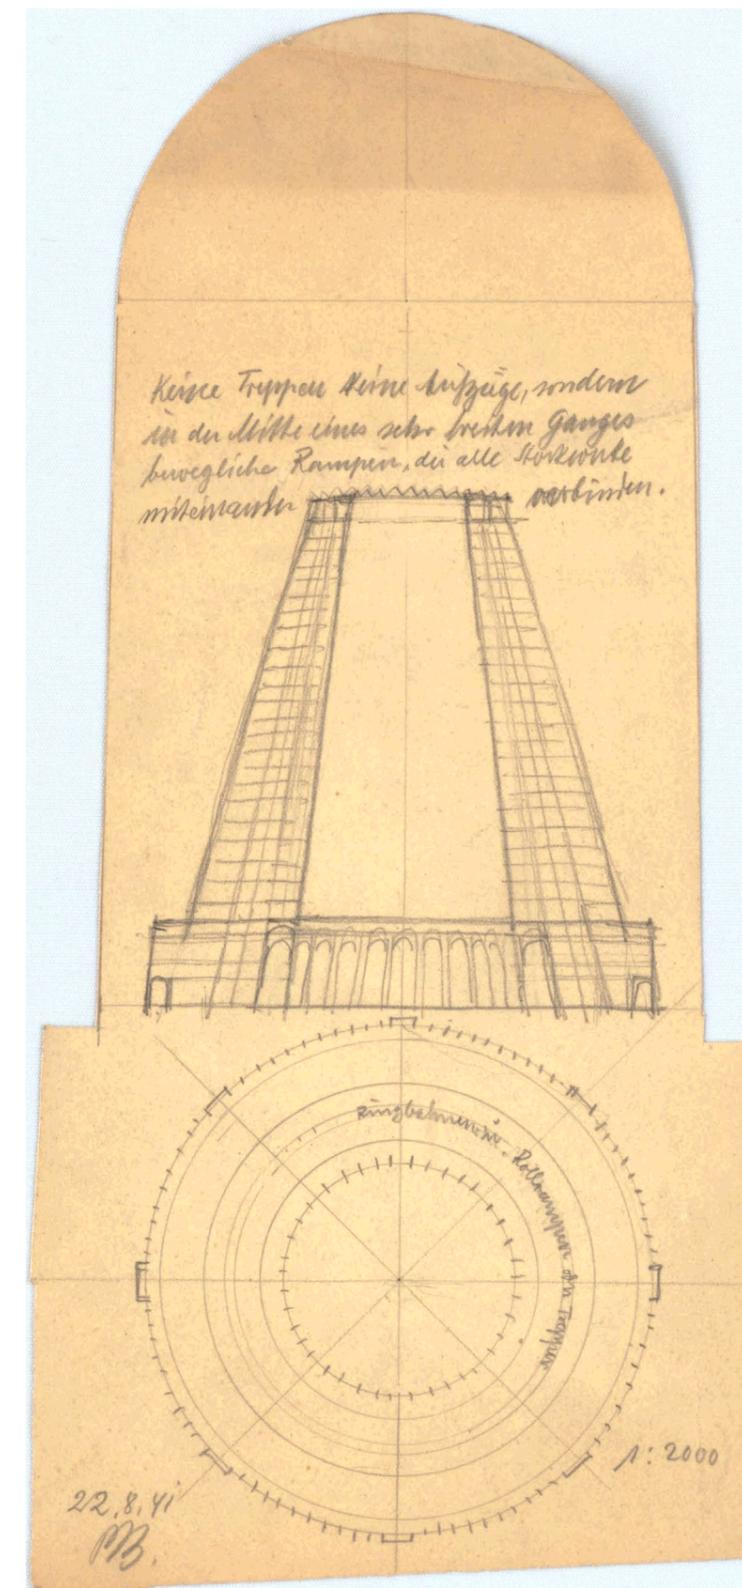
Platz der Technik, Grundriss/Schnitt, 22. August 1941
